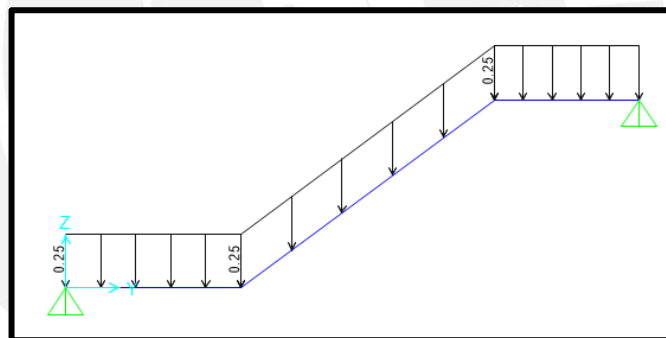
Vista de las cargas últimas sobre la viga longitudinal en SAP 2000
